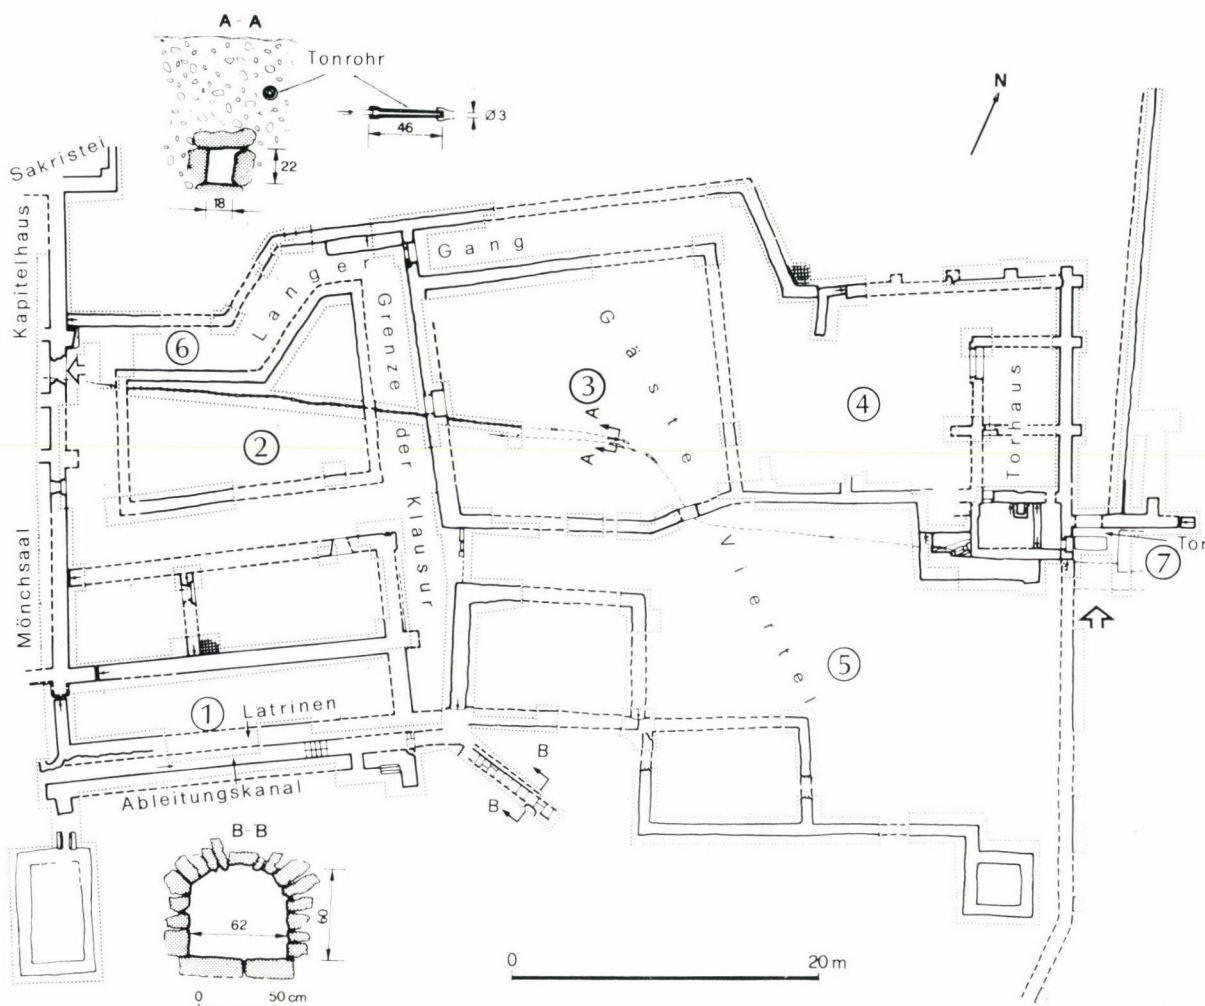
Grundriß der östlichen Höfe des Klosters mit dem Torhaus
